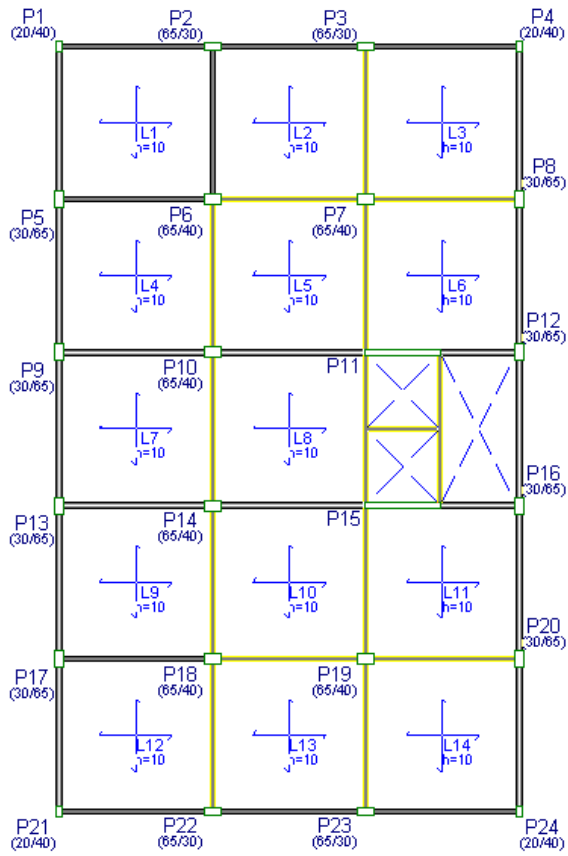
Planta baixa do pavimento tipo - CYPECAD 2008 [5]
